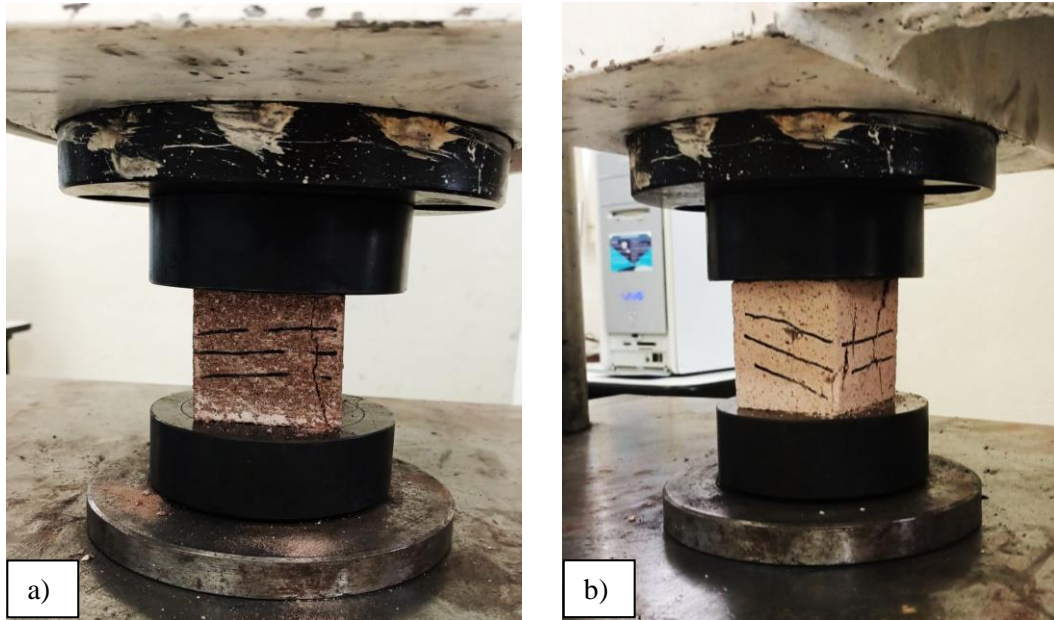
A) Probeta de toba café en la máquina universal para la prueba de compresión uniaxial. B) Probeta de toba blanca en la máquina universal para la prueba de compresión uniaxial.
